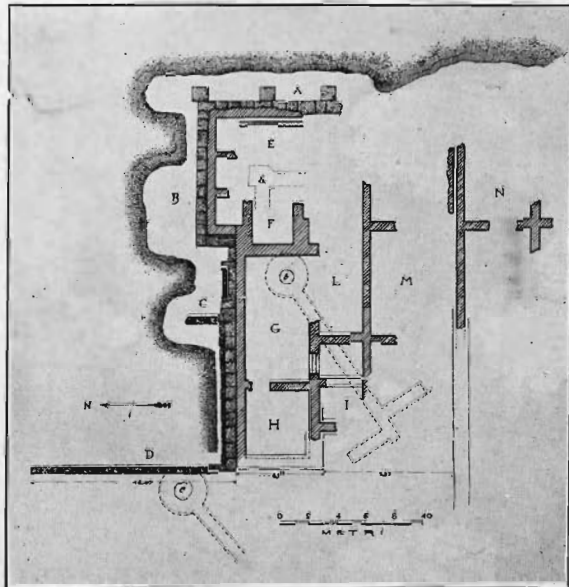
Pianta di antico edificio verso levante. Monte Cave.
